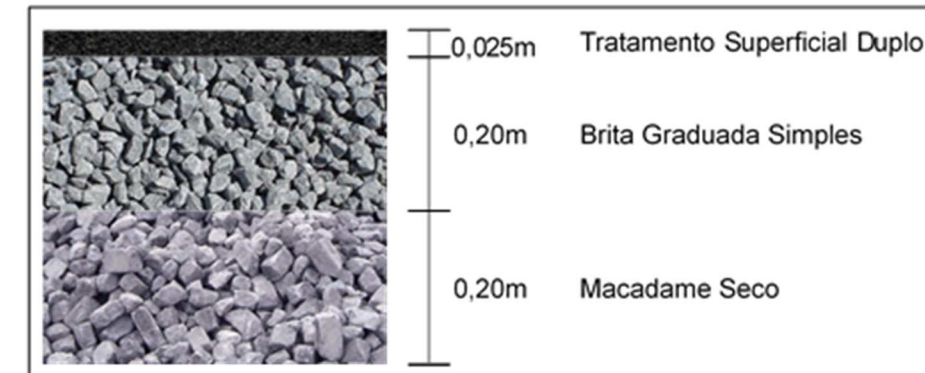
Estrutura do pavimento dos Acostamentos do Lote 6
